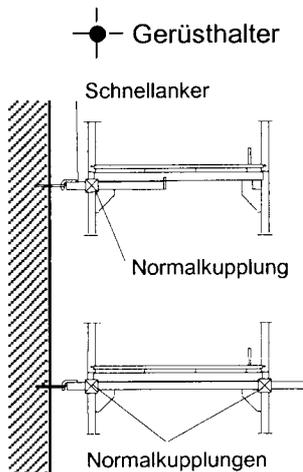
Unbekleidetes Gerüst, Grundvariante, $L \leq 2.57$ m
